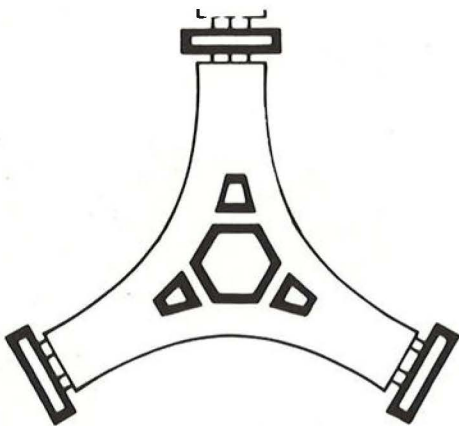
Stahlbetonhohlkörper der Stiegenhaustürme und des Zentralkerns im Grundriß eines Y-förmigen Gebäudes
